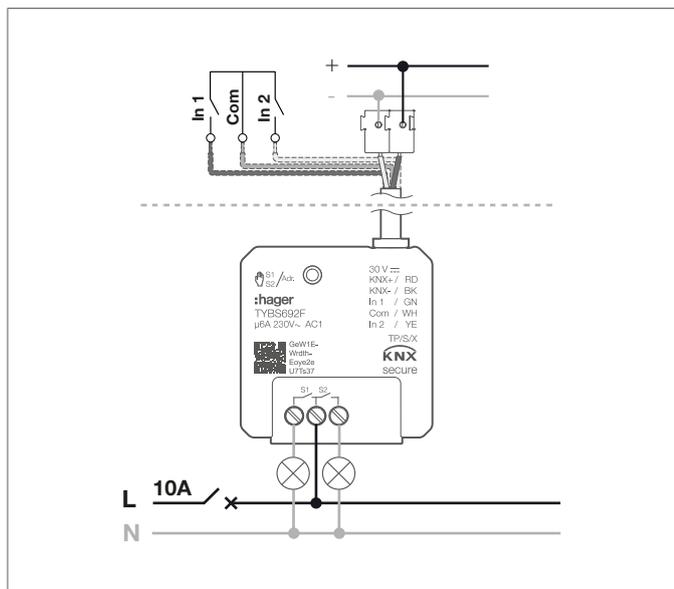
Schema di collegamento dell'utenza lampada TYBS692F
